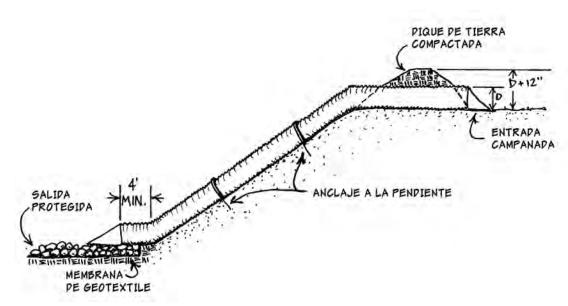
Figura A. Descripción la tubería de drenaje en laderas. En la parte superior, el dique con tierra compactada debe tener una altura de un pie más que el diámetro de la tubería. La tubería debe estar seguramente anclada a la pendiente. En la parte de abajo, los últimos 4 pies de tubería deben estar a nivel y la salida de la tubería debe estar protegida con rocas. Una membrana de geotextiles debe ser instalada entre el suelo y las rocas.
